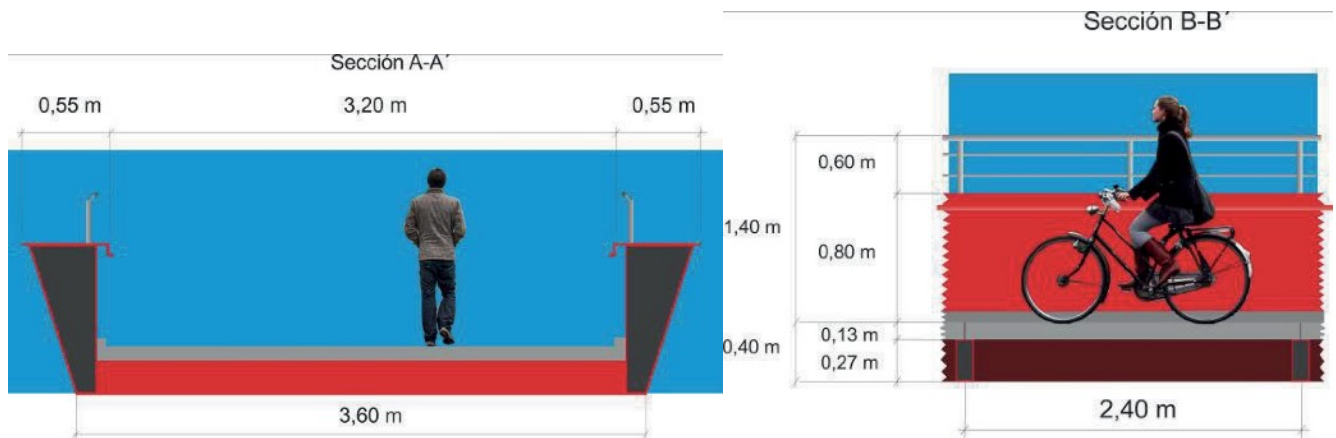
b. Detalle del corte de la sección A-A' y B-B' de la losa de hormigón y la estructura metálica.
